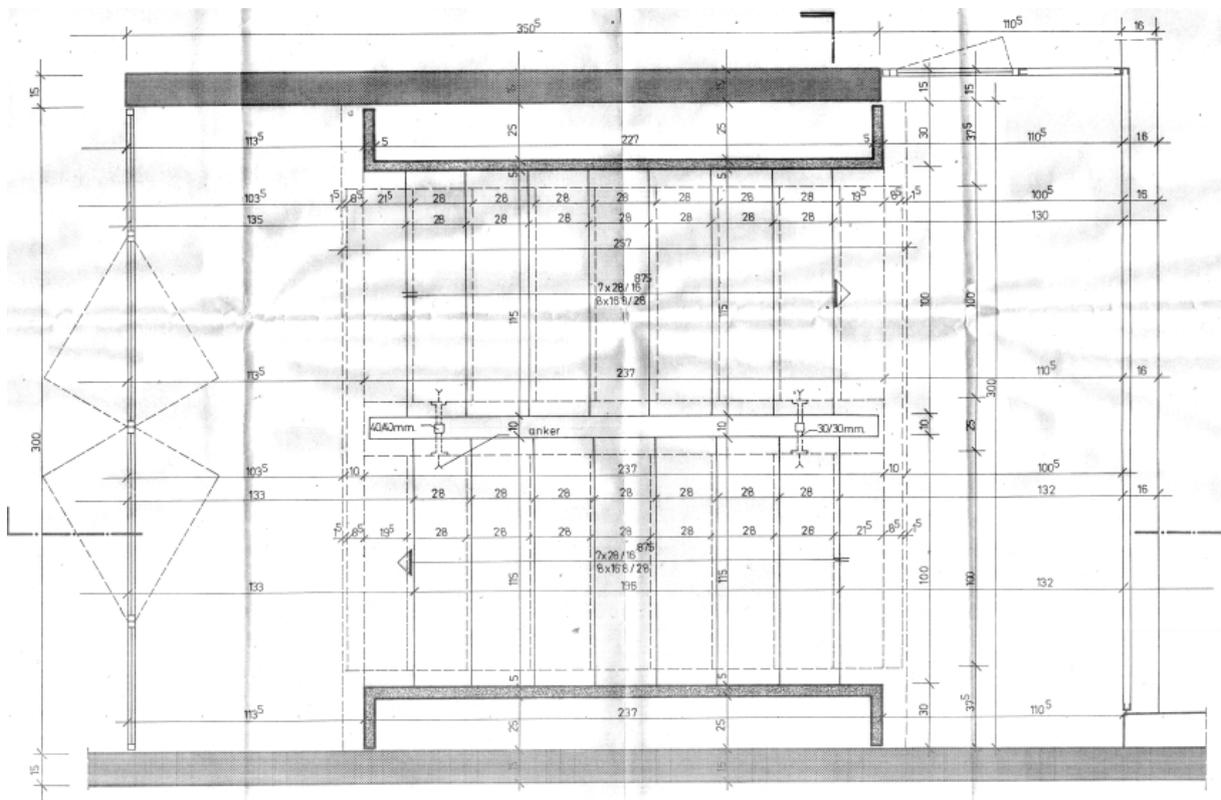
Stiegenhauskonstruktion im Grundriss (Fa. DOM Sarajevo)
